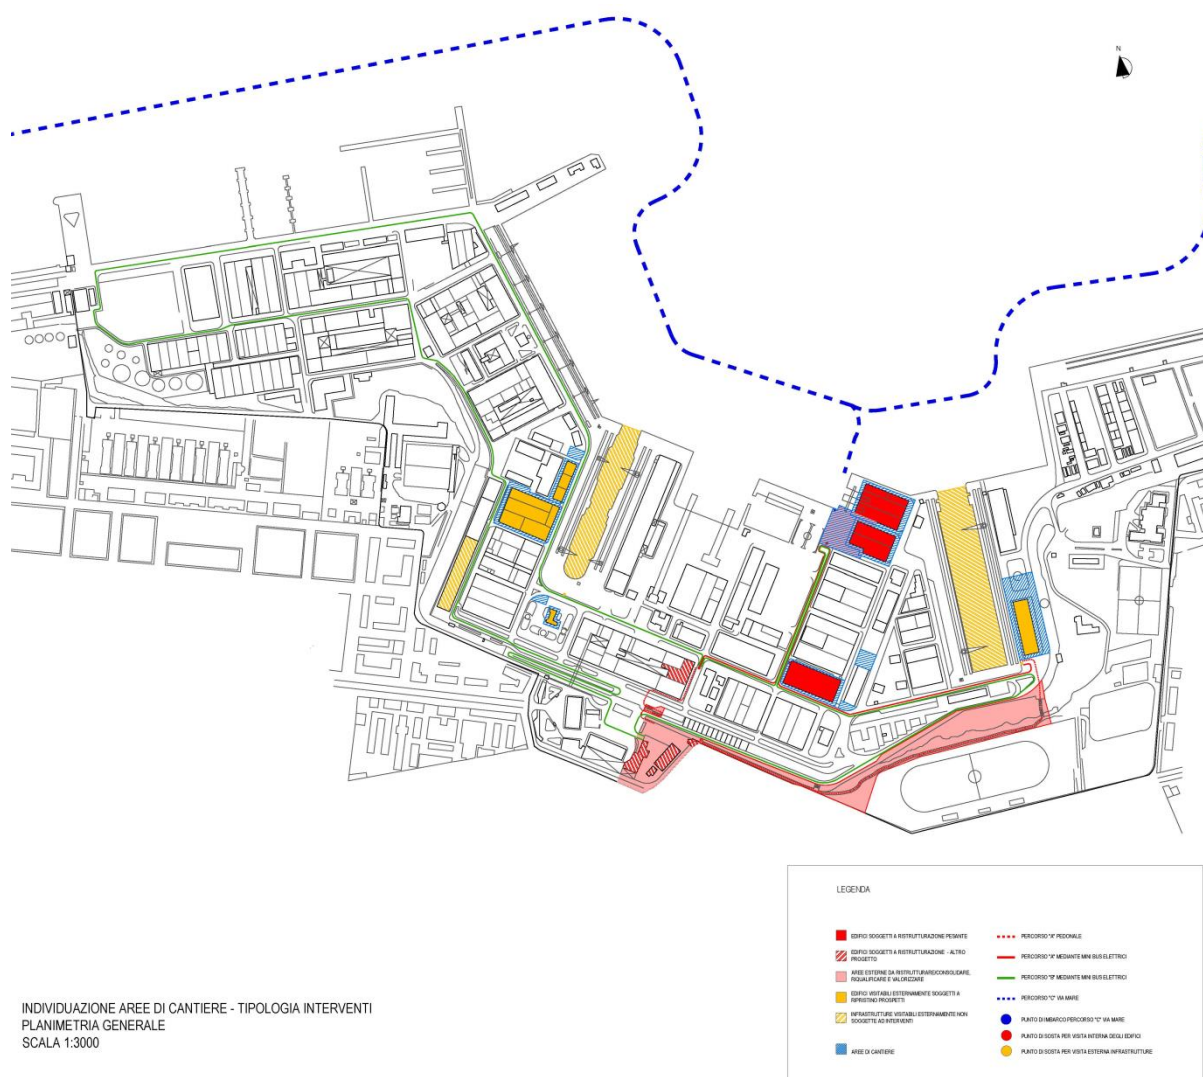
Localizzazione cantiere (vds G05 ALL1_ A1 AREE DI CANTIERE GEN)
